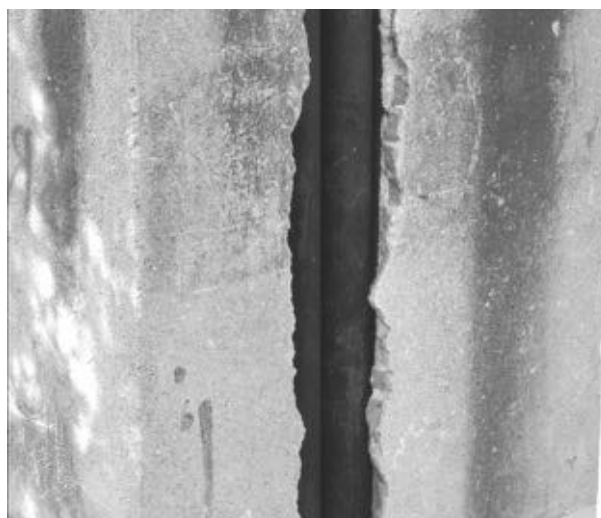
Rotura enprotección de columna de alta tensión por oxidación de tubo
